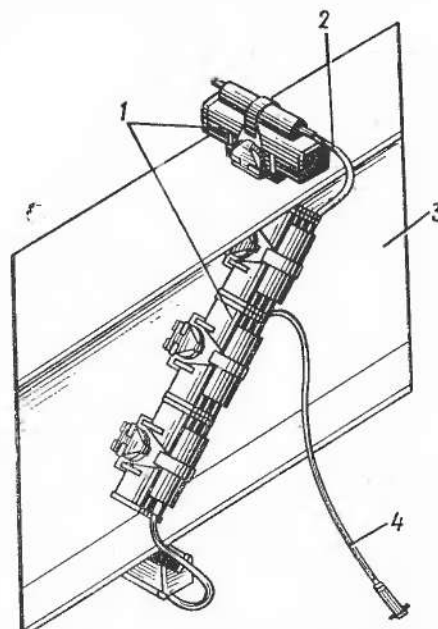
Установка заряда УМКЗ при разрушении двутавровой балки (вариант):
